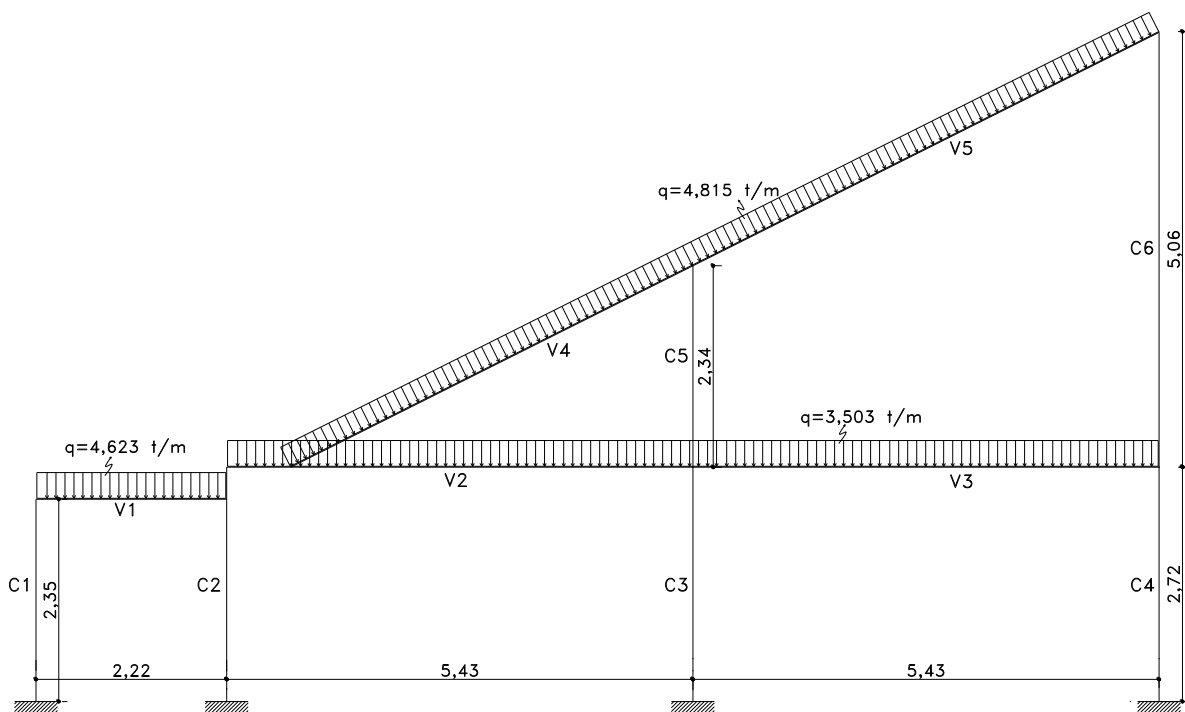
Pórtico bajo tribuna – Esquema estructural cargado
